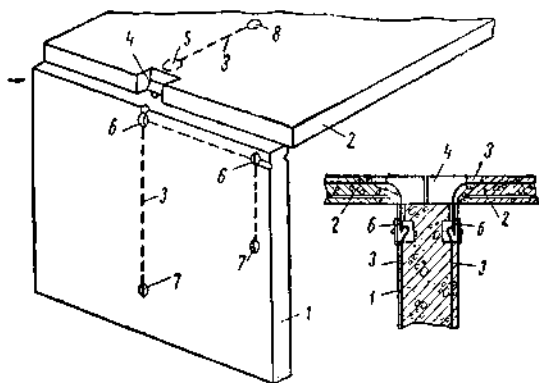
Узел сопряжения электропроводки, замоноличенной в стеновую и потолочную железобетонные панели
